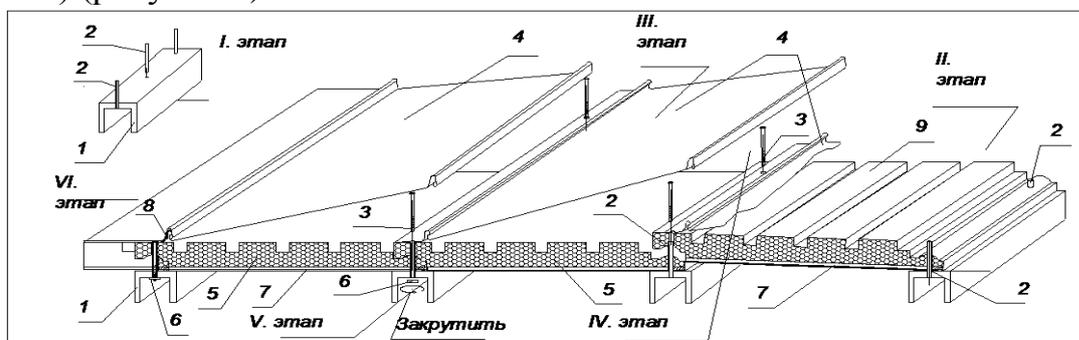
Технологическая схема устройства фальцевой кровли на основе унифицированных быстросборных элементов: 1 – стропила; 2 – дюбель-распорка; 3 – крепежный элемент; 4 – кровельный лист; 5 – термопанель; 6 – гайка; 7 – каркас из фанеры; 8 – уплотнитель; 9 – ветро–влагозащитная мембрана
